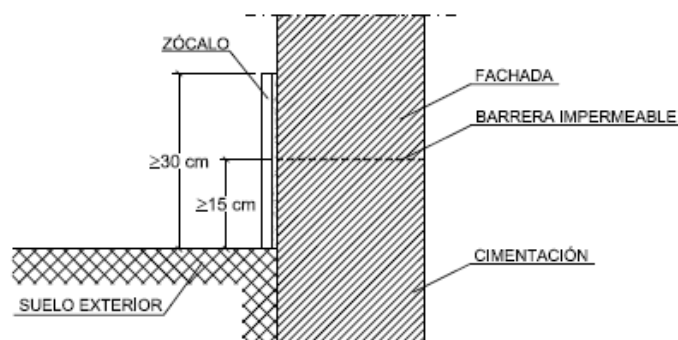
Ejemplo de arranque de la fachada desde la cimentación
